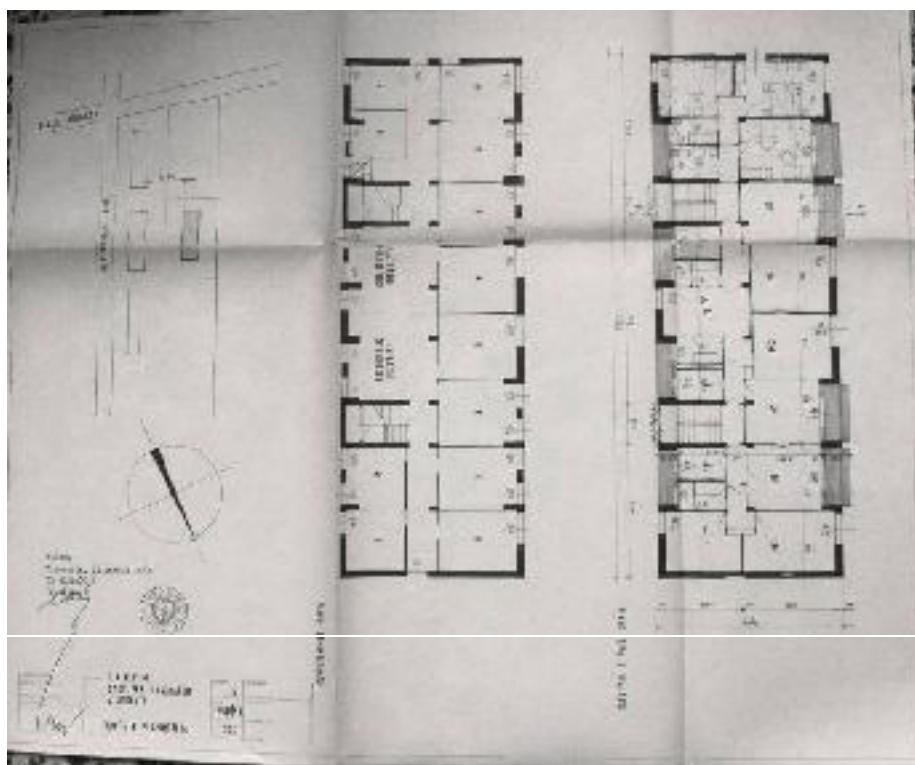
Carlo Villa, edificio Ina Casa a Vimercate, planimetria e piante (ACV)
